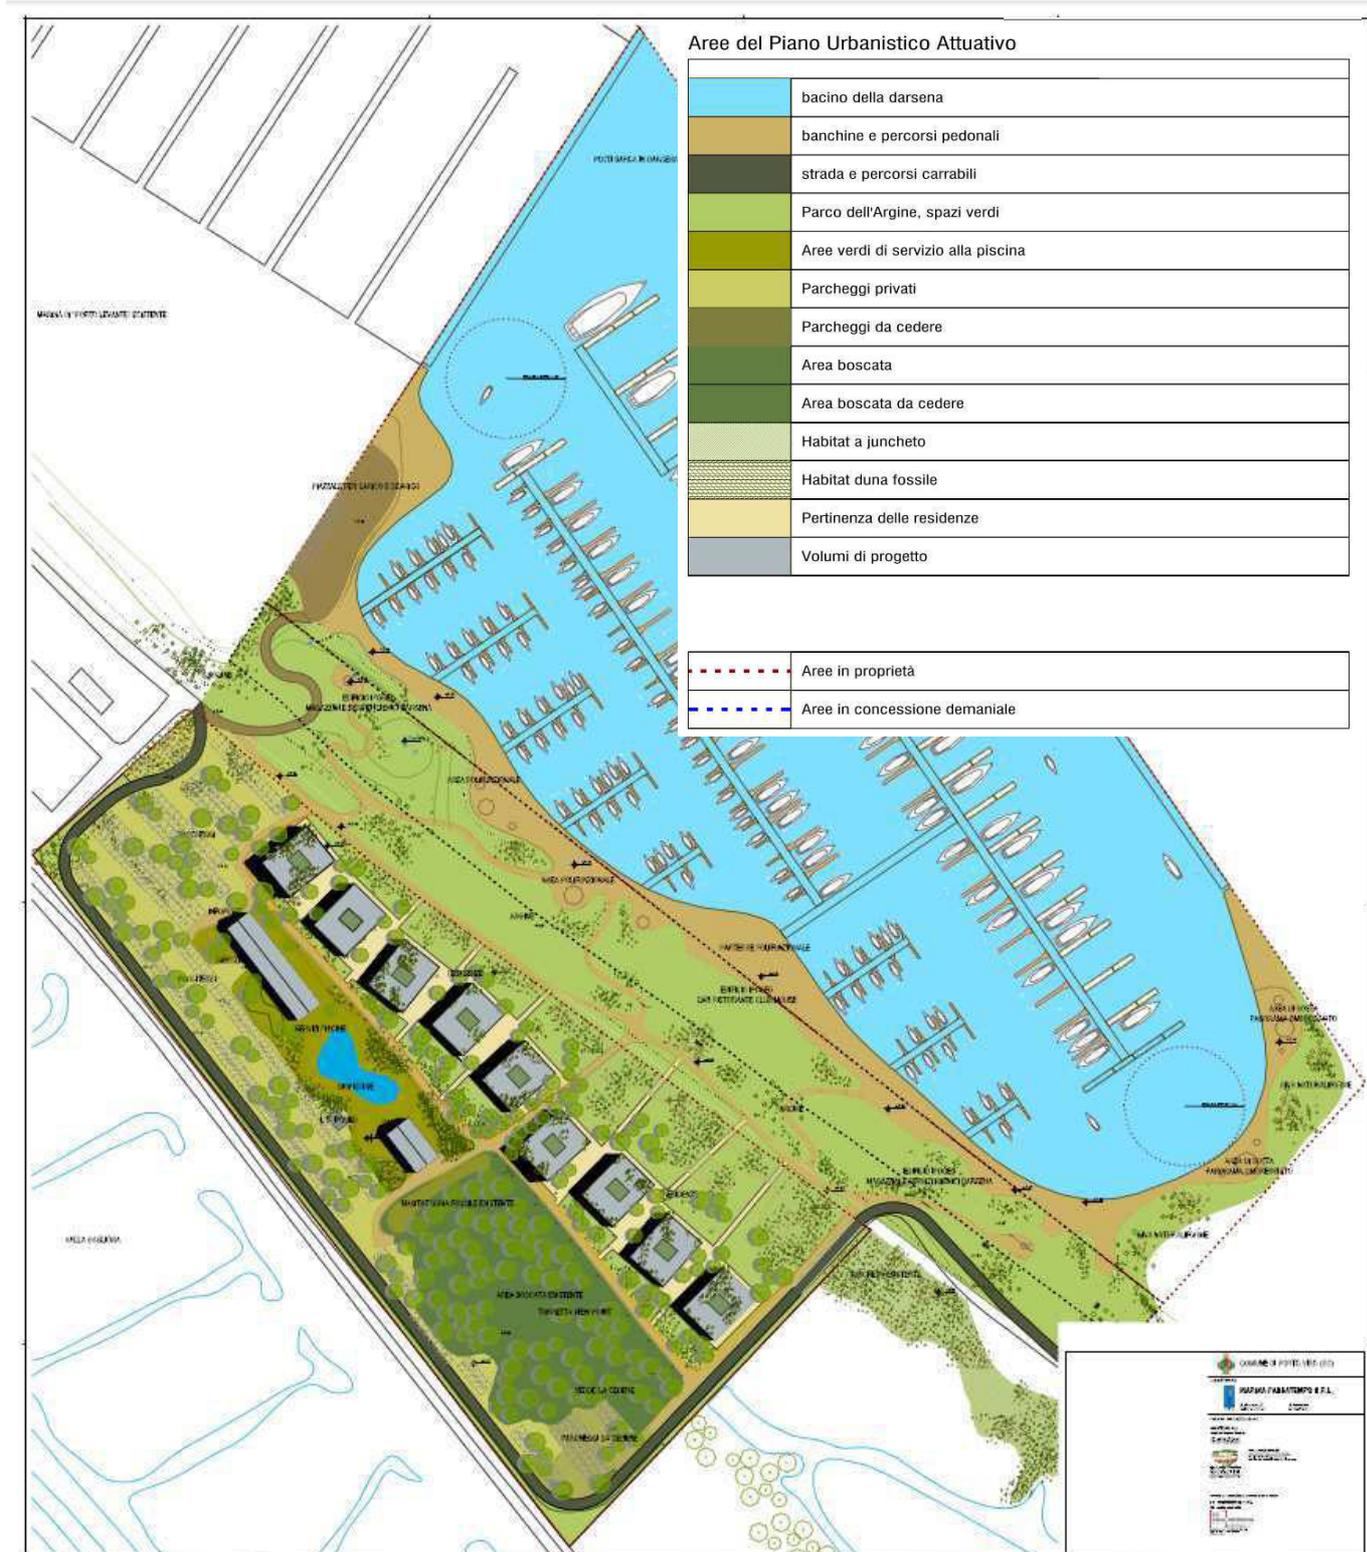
Planivolumetrico dell'area oggetto del nuovo Piano Urbanistico Attuativo
